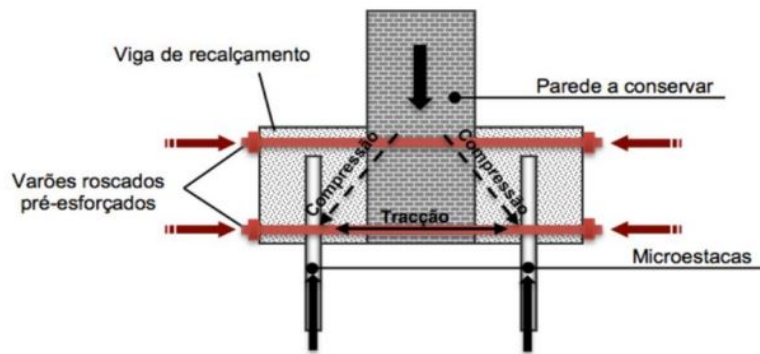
Mecanismo de contenção de fachada. Retirado de [9]
